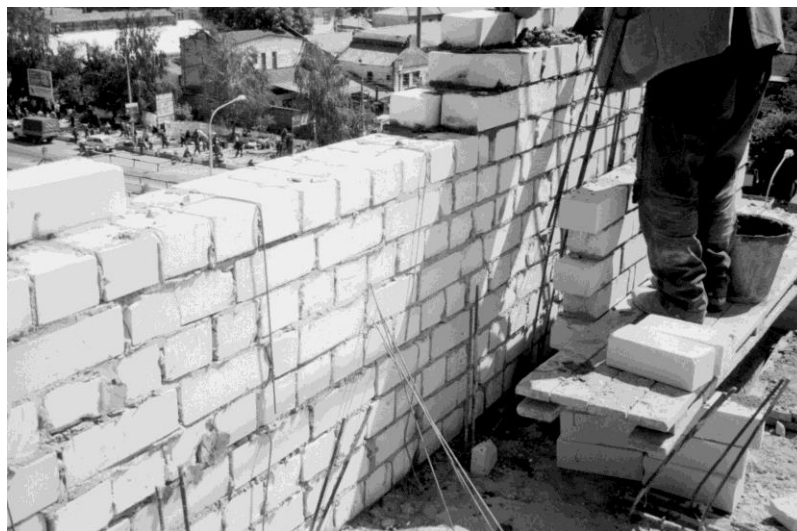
Наружная стена 12-этажного жилого здания в г. Краснодаре
